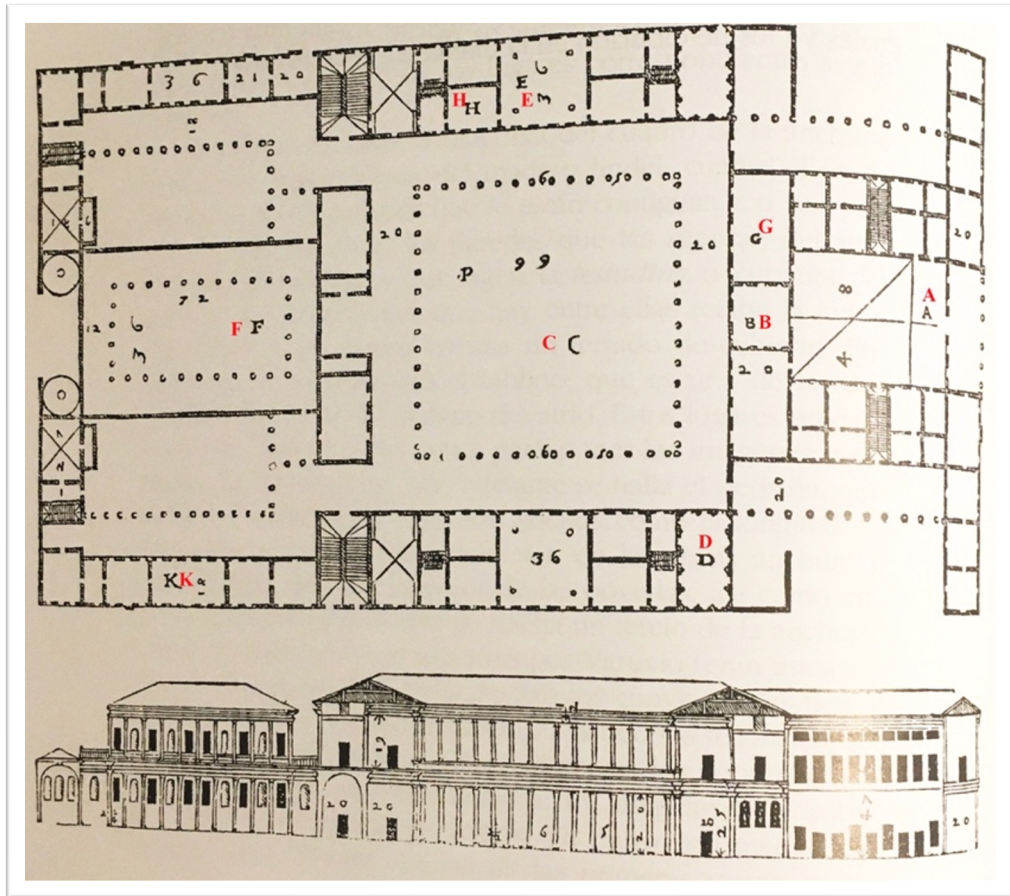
Planta arquitectónica y corte de una casa romana. Interpretación de Andrea Palladio.
